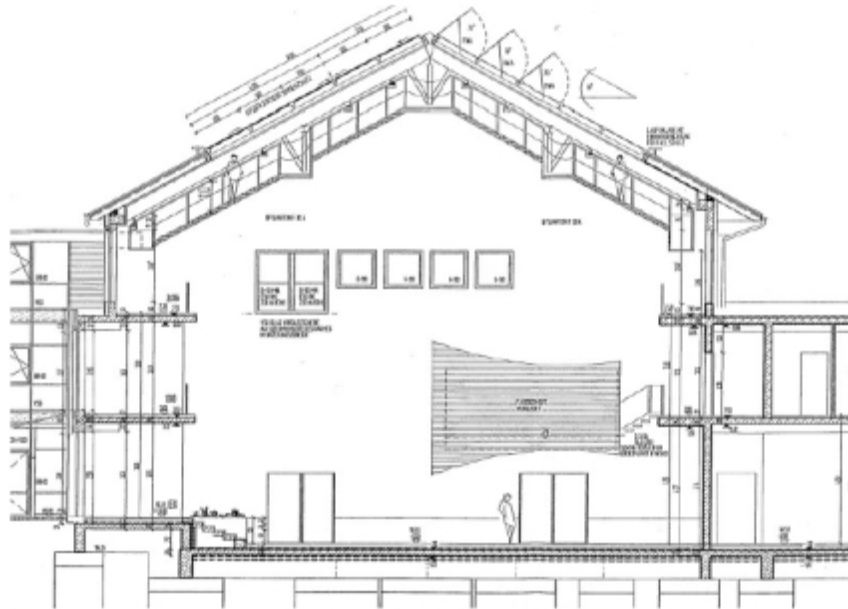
Gebäudeschnitt Quer durch das Gebäude Haus A. (Quelle: Ausführungsplan Architekturbüro Grundmann & Partner 09.09.2002)
